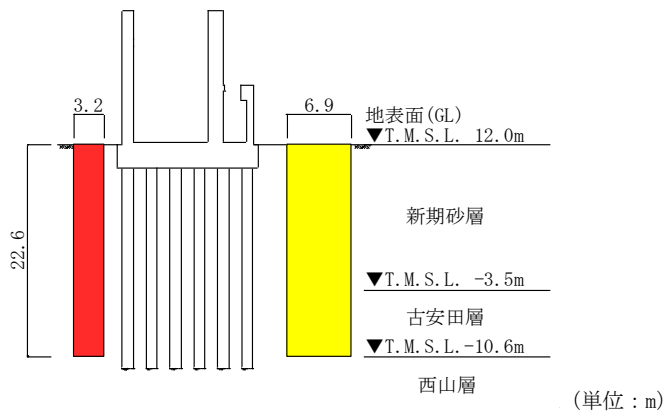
地盤改良体の配置図 (大物搬入建屋)
